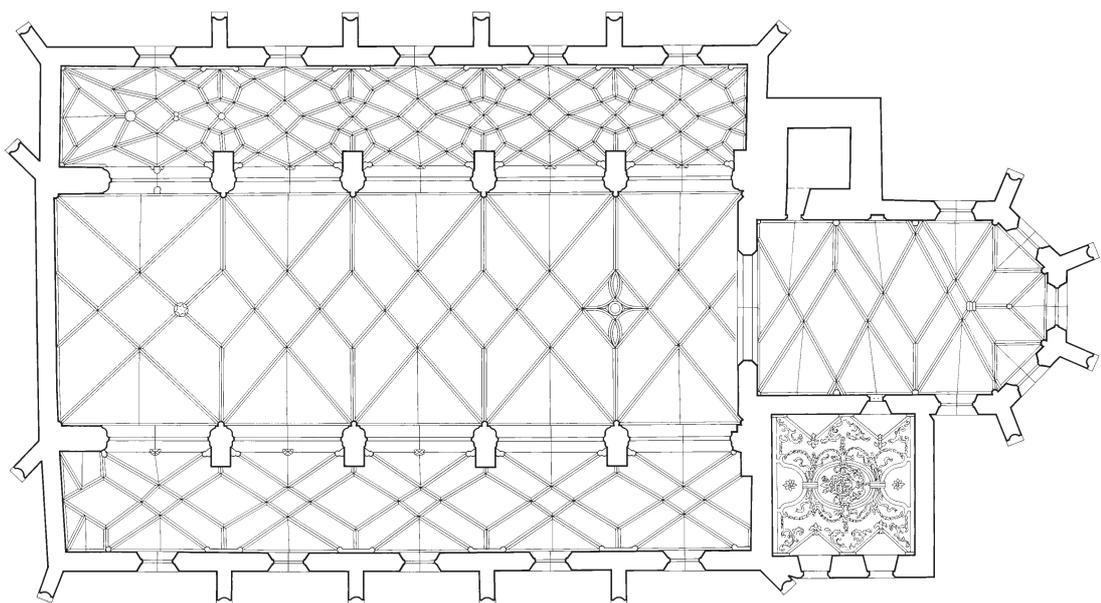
Zug, Kirche St. Oswald. Grundriss 1:300.
